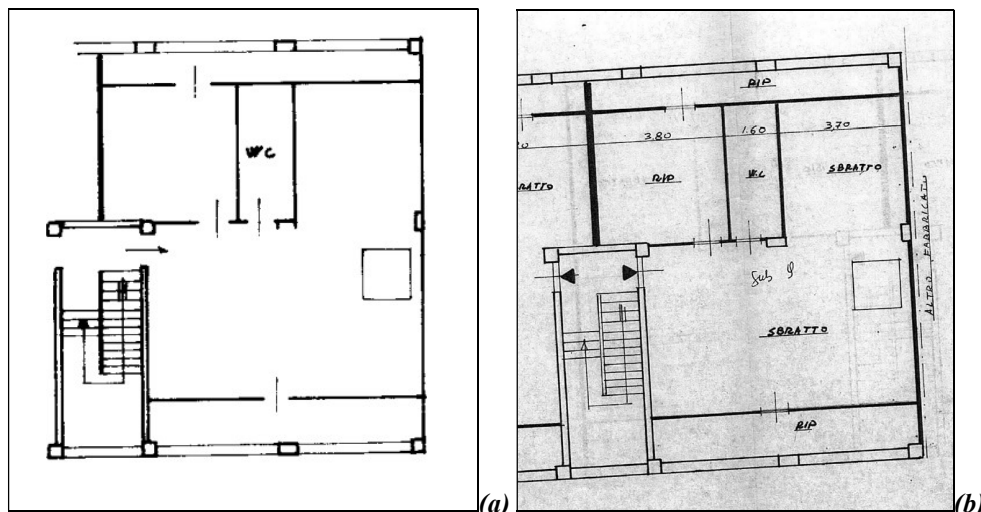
Planimetria della soffitta annessa all'appartamento ubicata in via Leonardo Cera n° 7 – interno 6 piano 3: planimetria catastale (a); planimetria di progetto (b).
